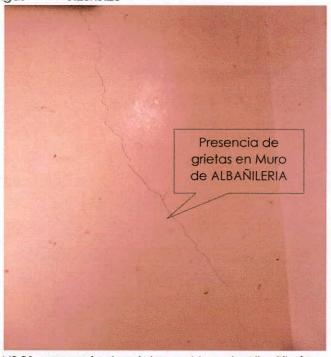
Módulo Nº 01, presencia de grietas en Muro de Albañilería.
